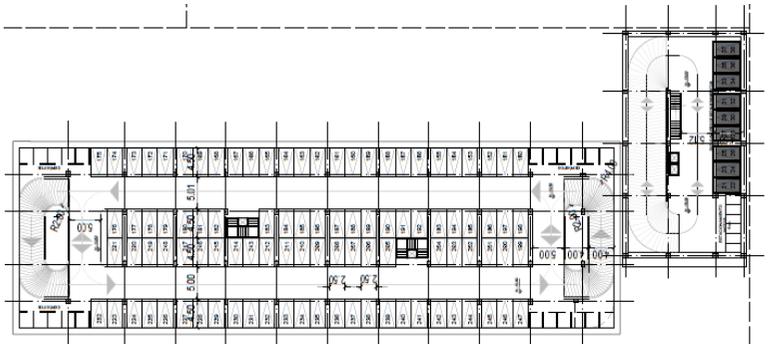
PF13. Planta Estacionamientos – Sótano 3
